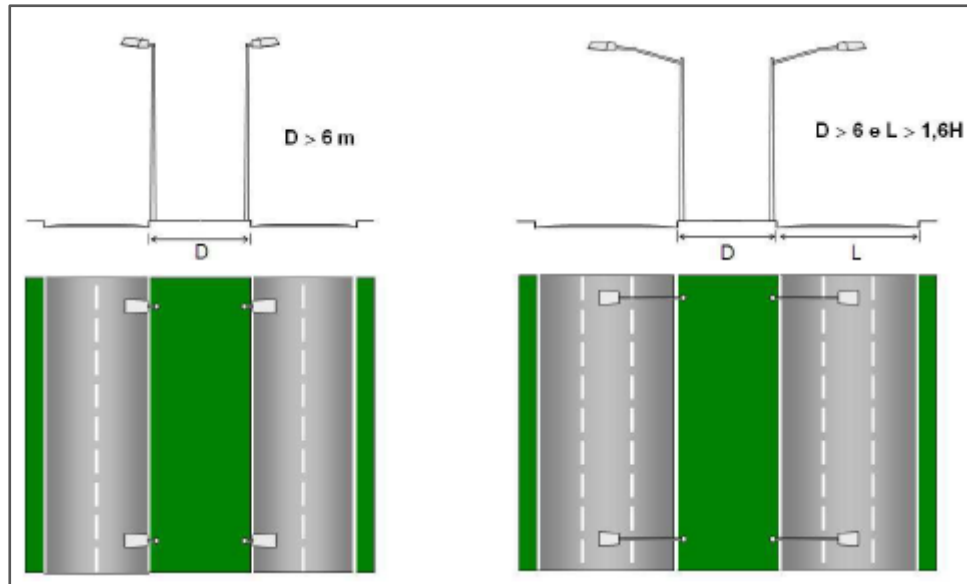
Condição para utilização de posteação central em canteiro ≥ 6 m
